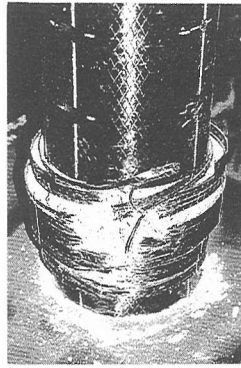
帯鉄筋だけで補強した試験体の破壊性状
